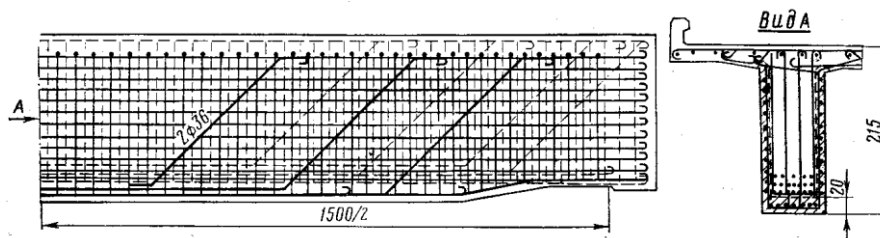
Усиление пролетного строения железобетонной оболочкой (на фасаде балки показана только арматура усиления)
